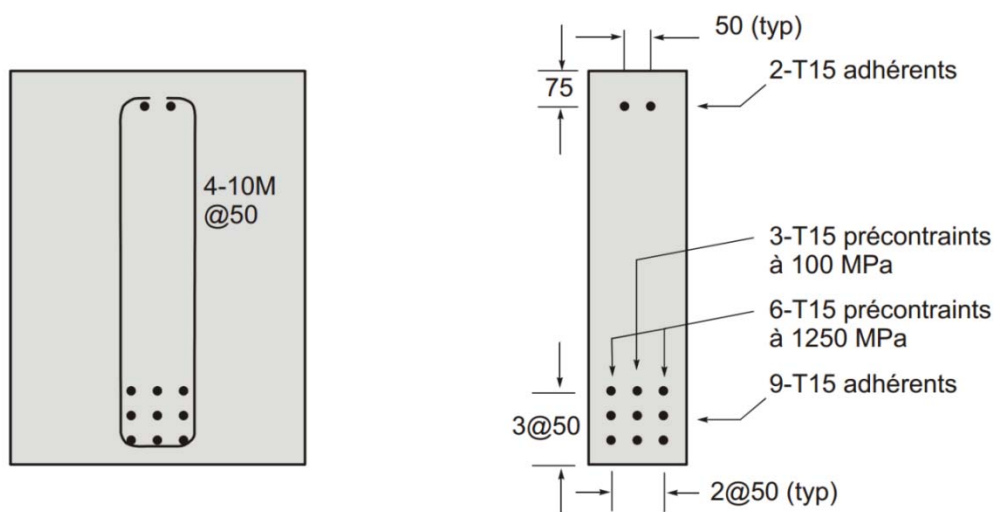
Croquis du ferrailage des poutres R06-1 et R06-2
